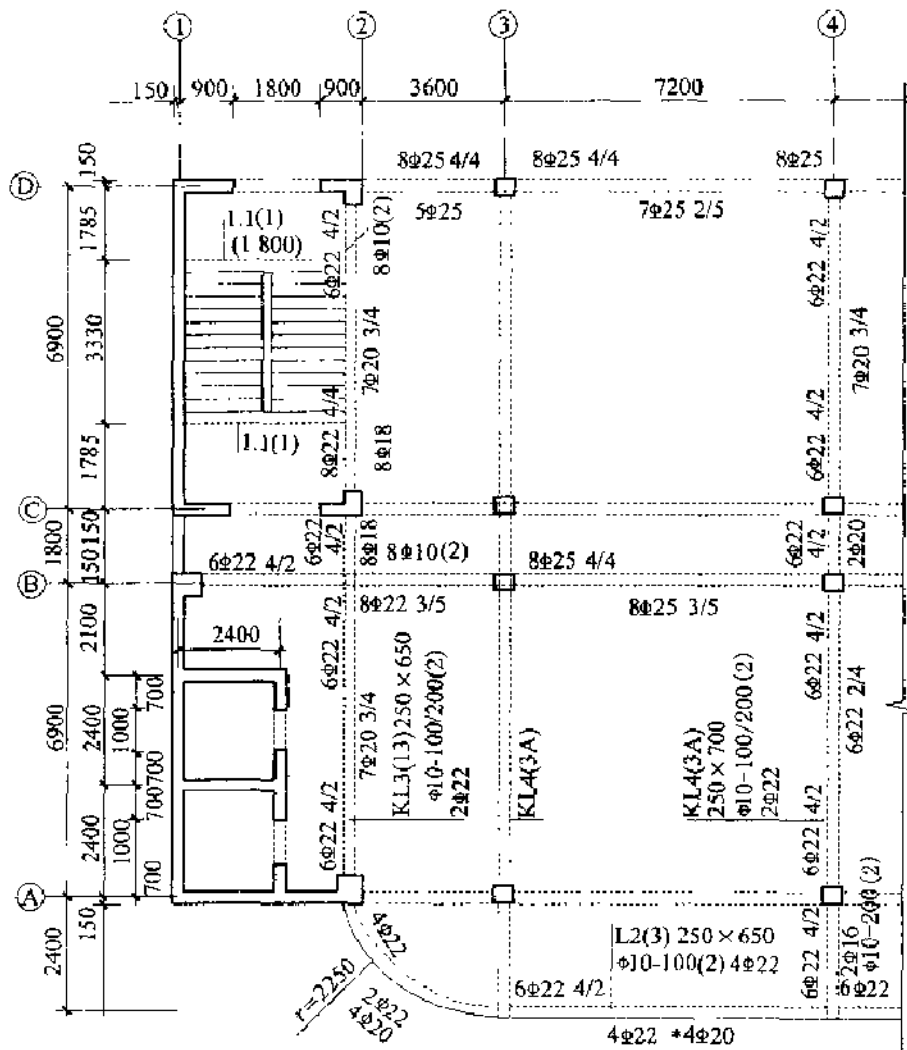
15.870—26.670 梁平法施工图平面注写方式
